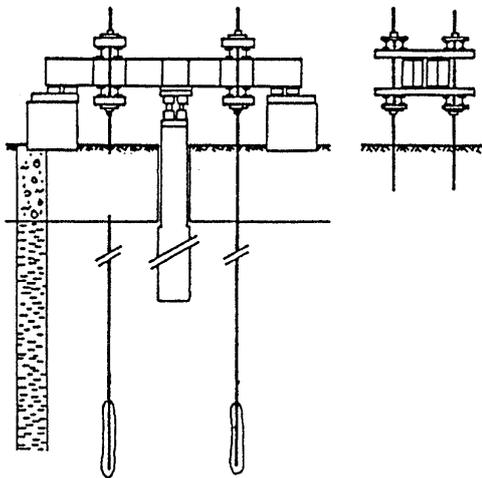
Probelastung durch Jochträger (Stahl) und Erdanker
